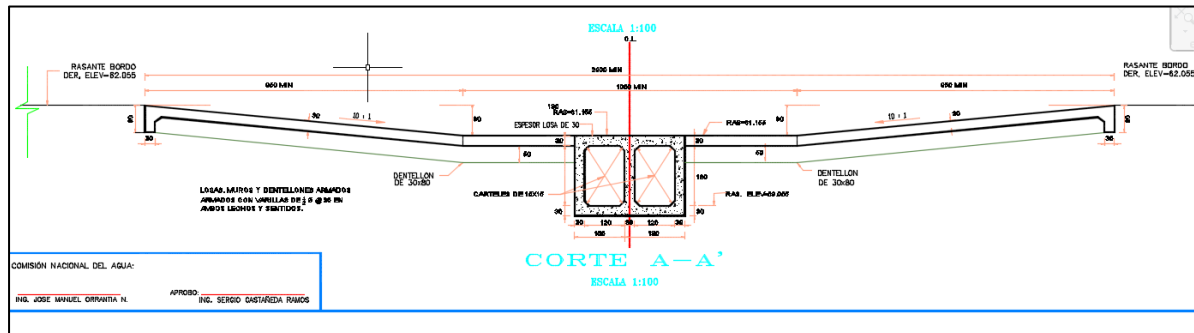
Estructura tipo vado de dos conductos de entrada de agua, vista en corte.
